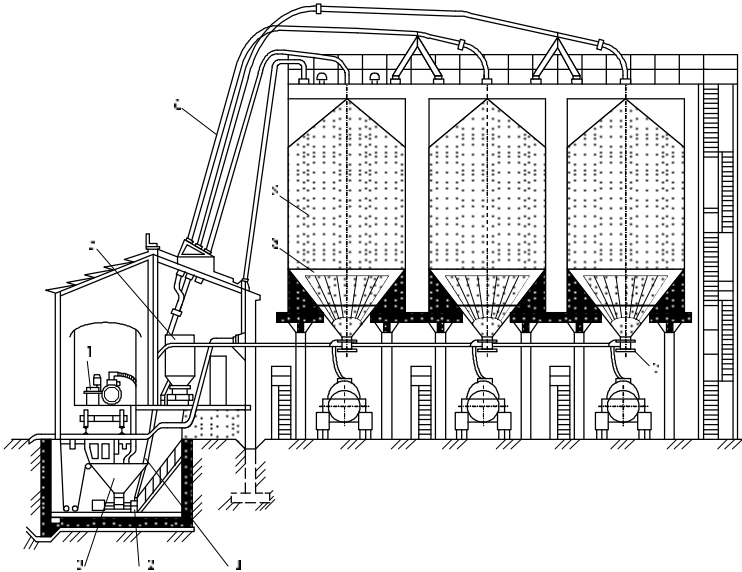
Схема комплексной механизации перегрузки и хранения пылевидных грузов: 1,6 – трубопроводы; 2 – пневмоподъемник; 3 – бункер; 4 – заборное устройство; 5 – осадительная камера; 7 – донный пневморазгрузчик; 8 – аэрационный сводоразрушитель; 9 – груз
